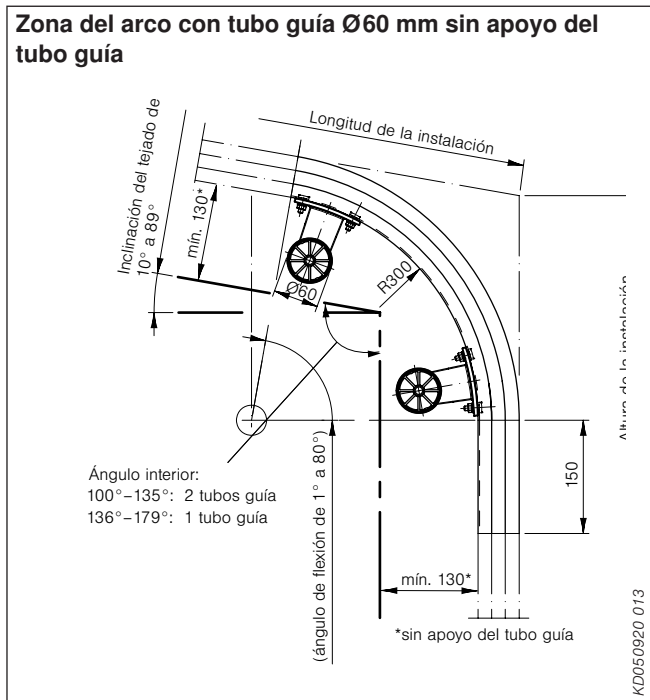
Zona del arco con tubo guía (sin apoyo del tubo guía)
